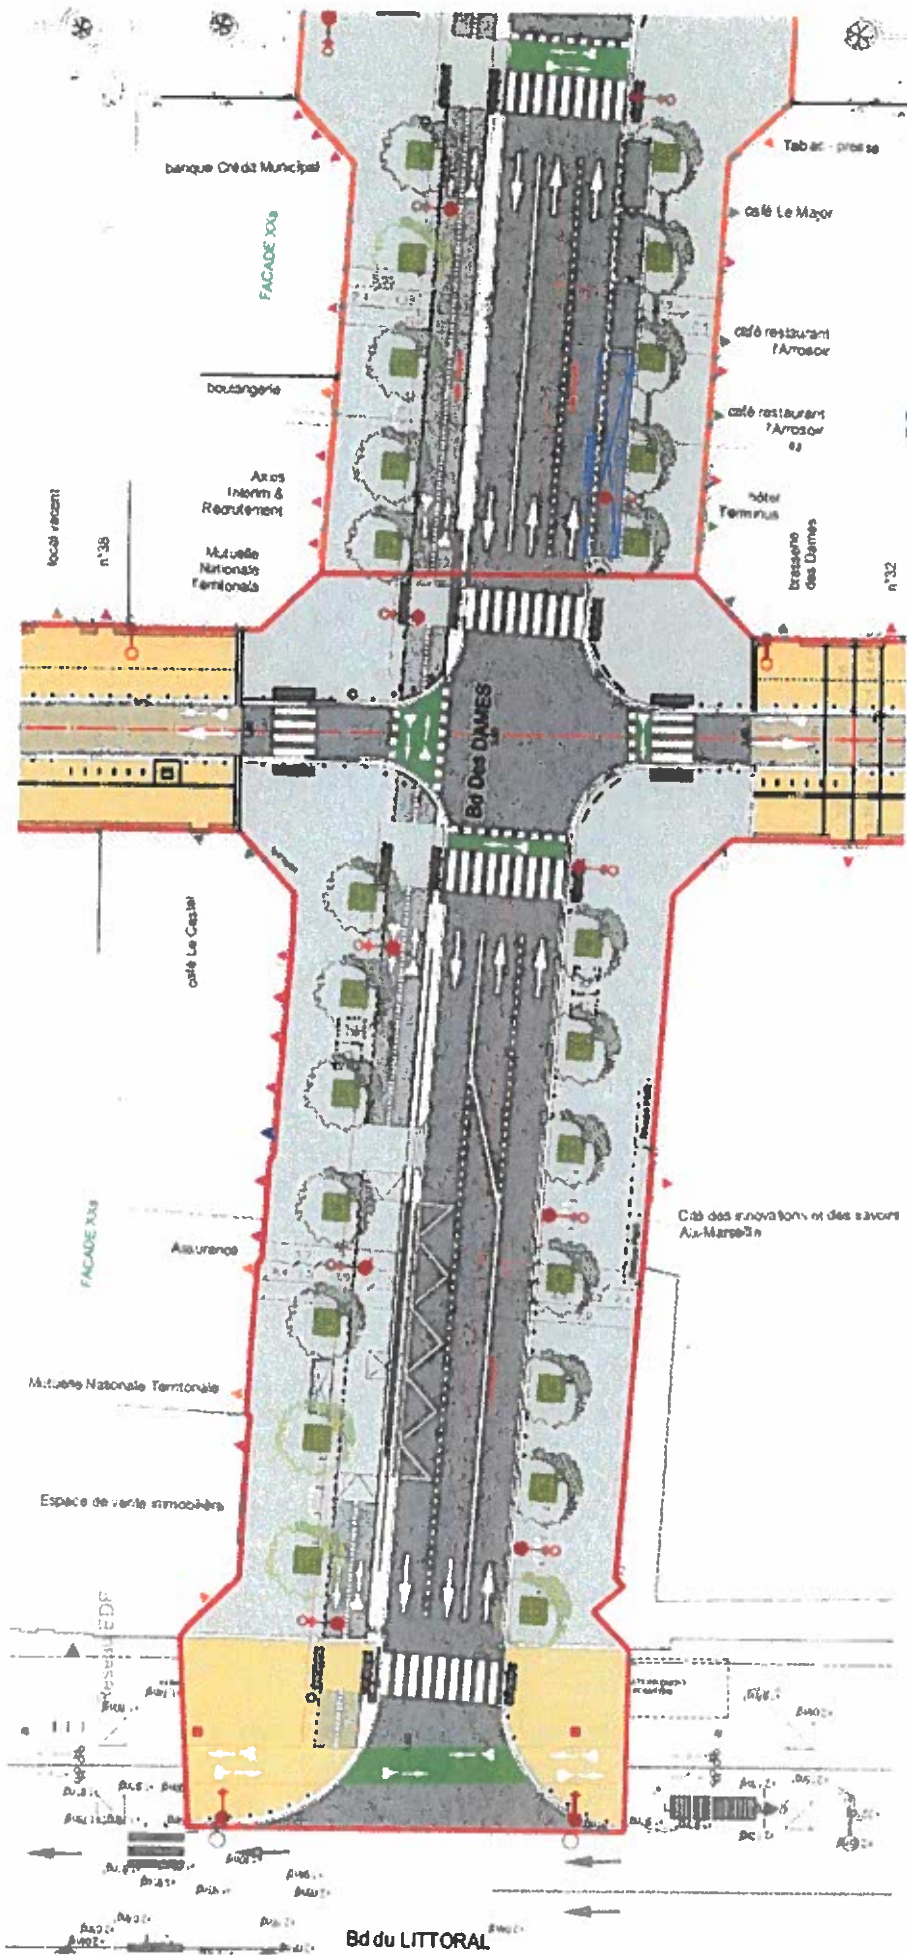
Plan Général des Travaux (2/6) - Section Boulevard des Dames
